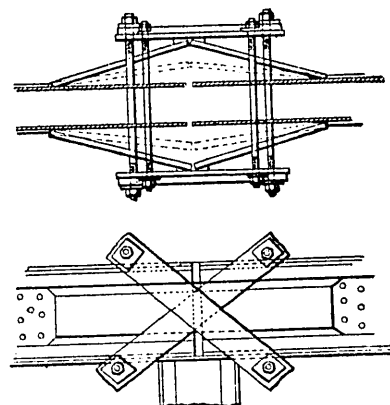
Aparato empleado para dar al larguero la compresión prevista en el proyecto
